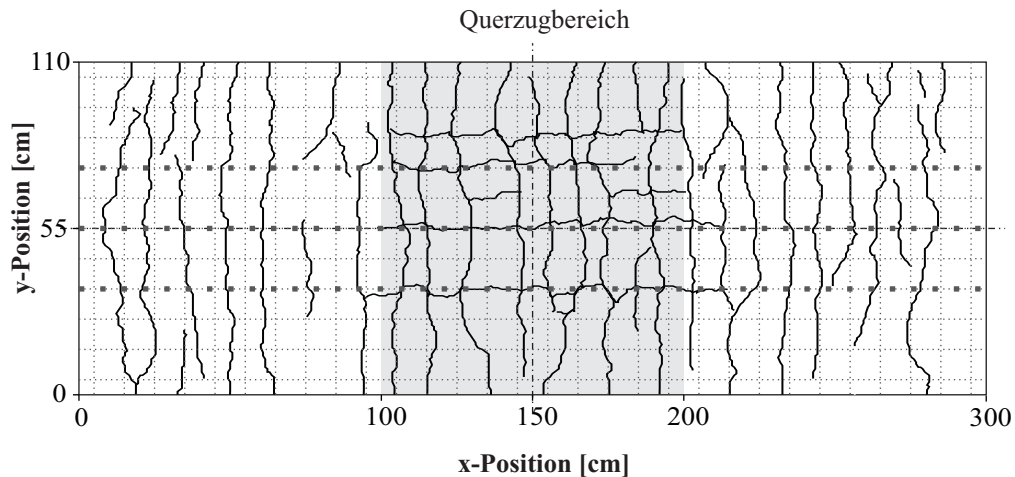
Rissbild Versuch 9, Lastpfad A
